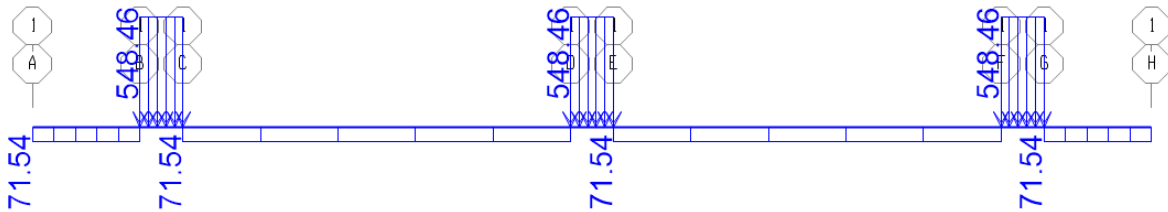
Cargas aplicadas sobre el modelo de viga generado en SAP2000.v20.
